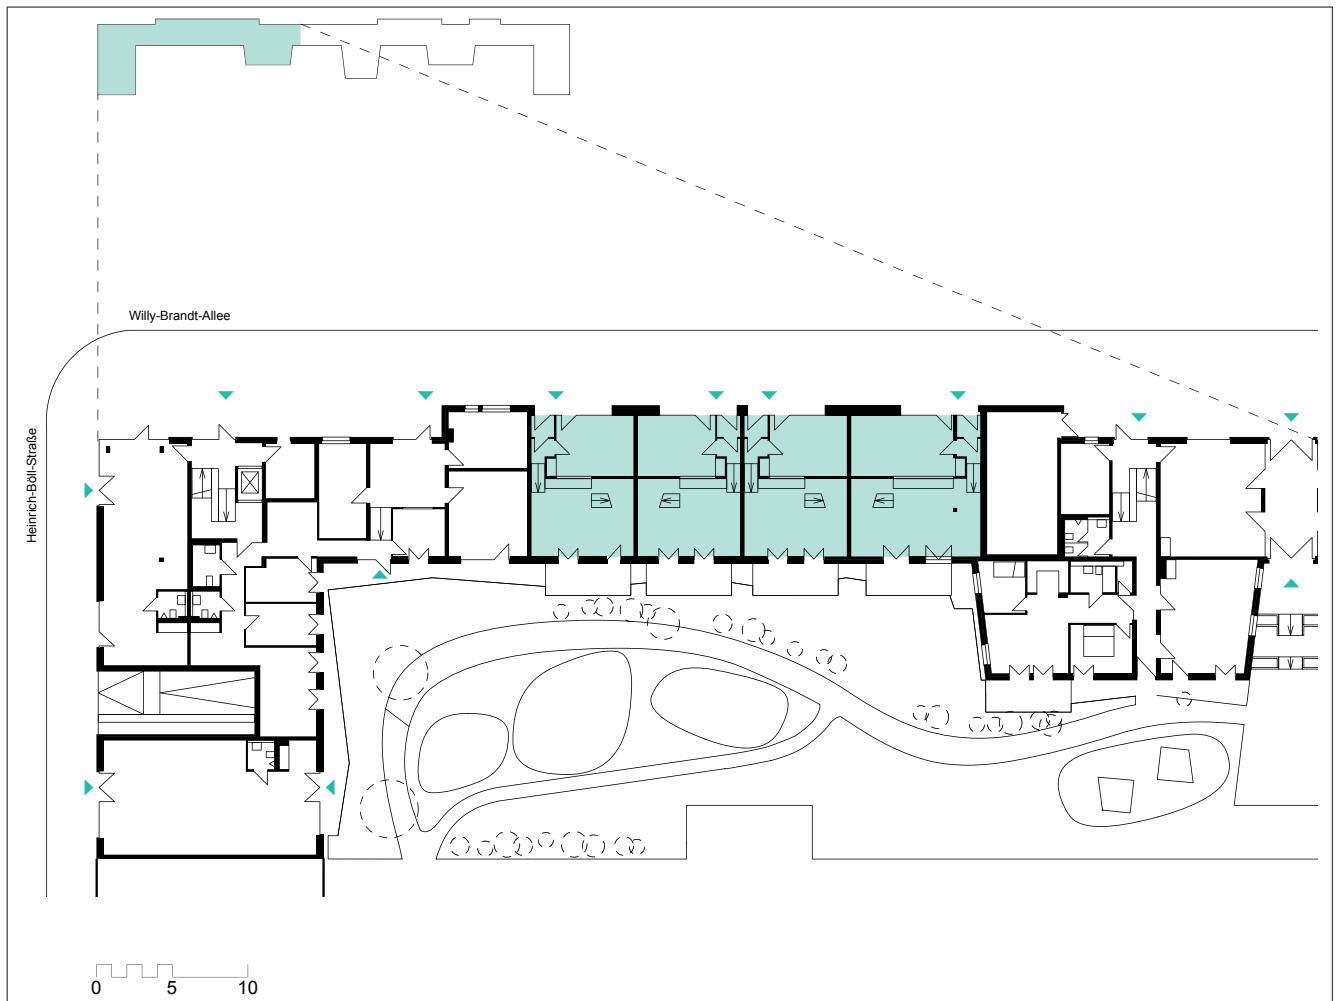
Teilgrundriss vom Erdgeschoss mit Ladenzone, Gemeinschaftsflächen und der Sonderform Ladenwohnung (grün) © Architektur Zwingel/Dilg, Bearbeitung subsolar
